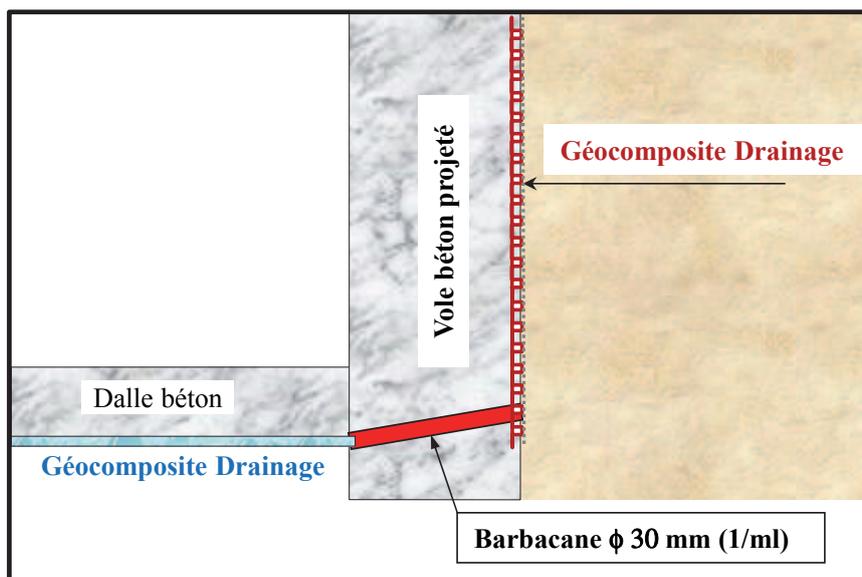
Connexion du drainage vertical avec le drainage horizontal par barbacanes
